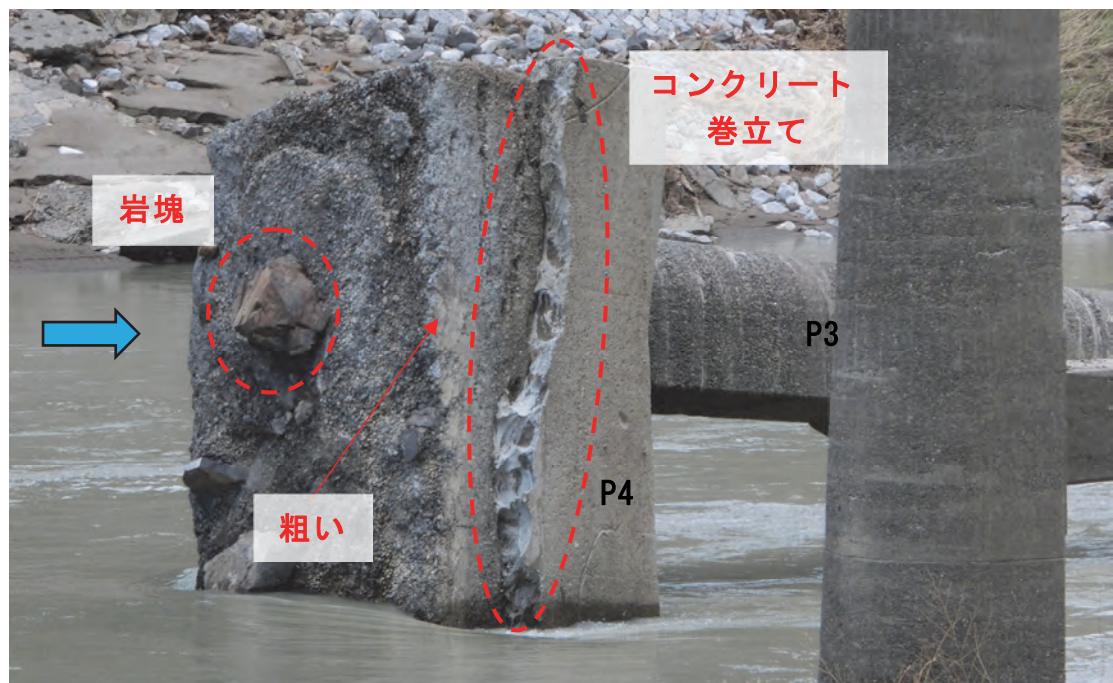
倒壊した P4 橋脚の基礎底面
